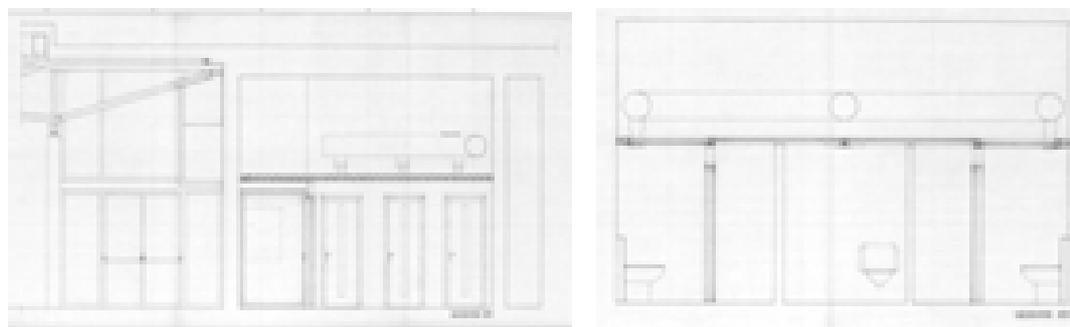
SX, Bagni, sezione EE – opere di completamento – 16/10/1997 (AABS-772)
